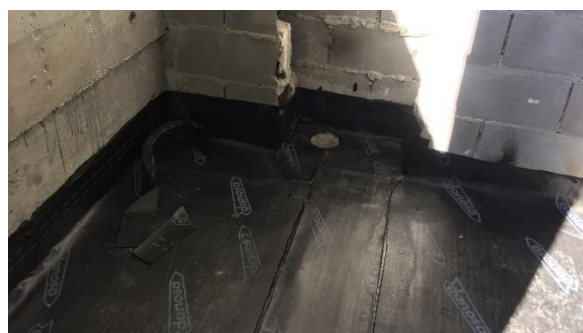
Impermeabilização utilizando telas asfálticas betuminosas [Data: 06.04.2017]
